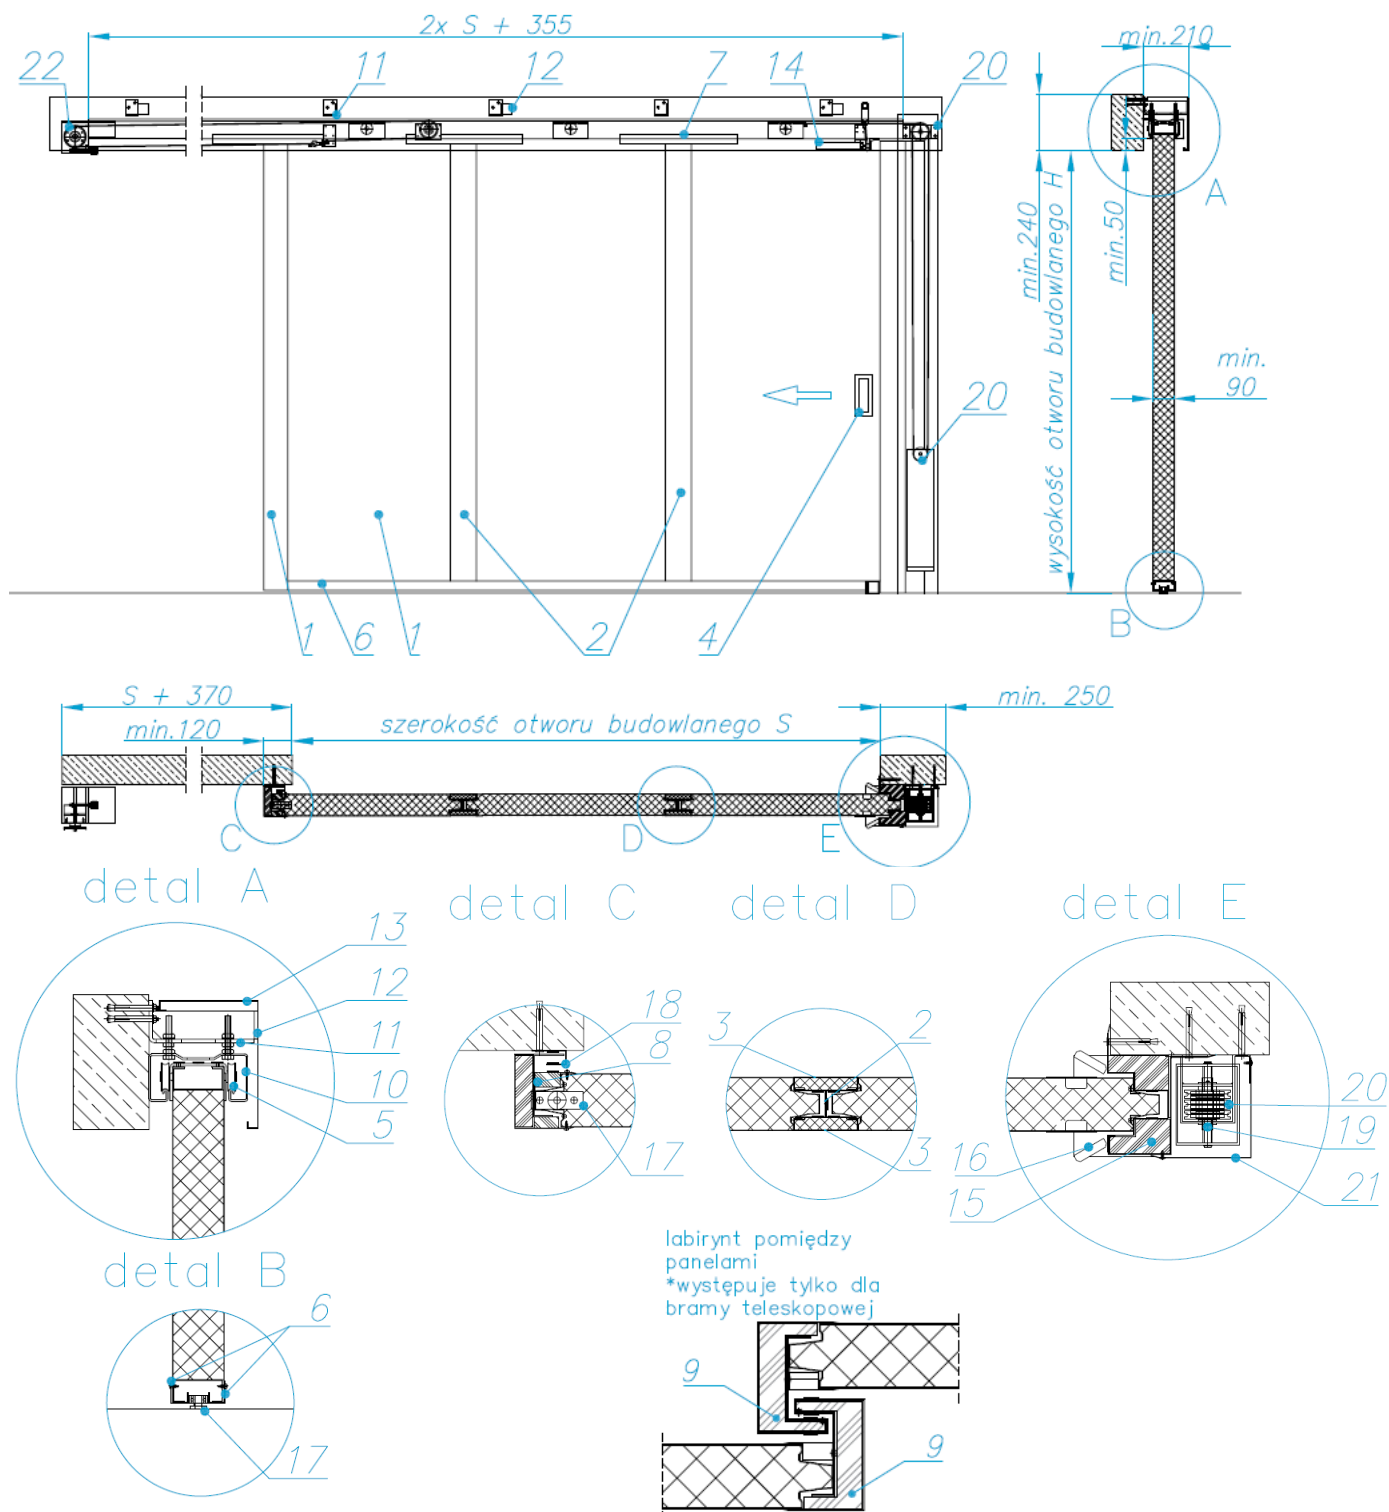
Brama TLB EI60 rozsuwana teleskopowa 2 segmentowa
